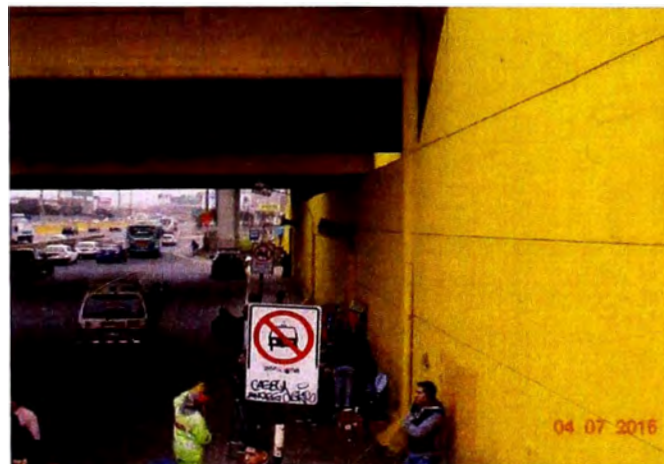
Vista del muro de concreto que impide el acceso al estribo.
